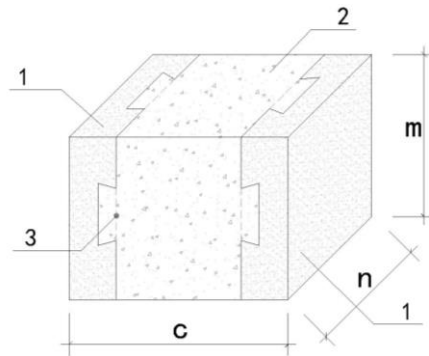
有皮混凝土试件即石材试件实样对称布置示意图
